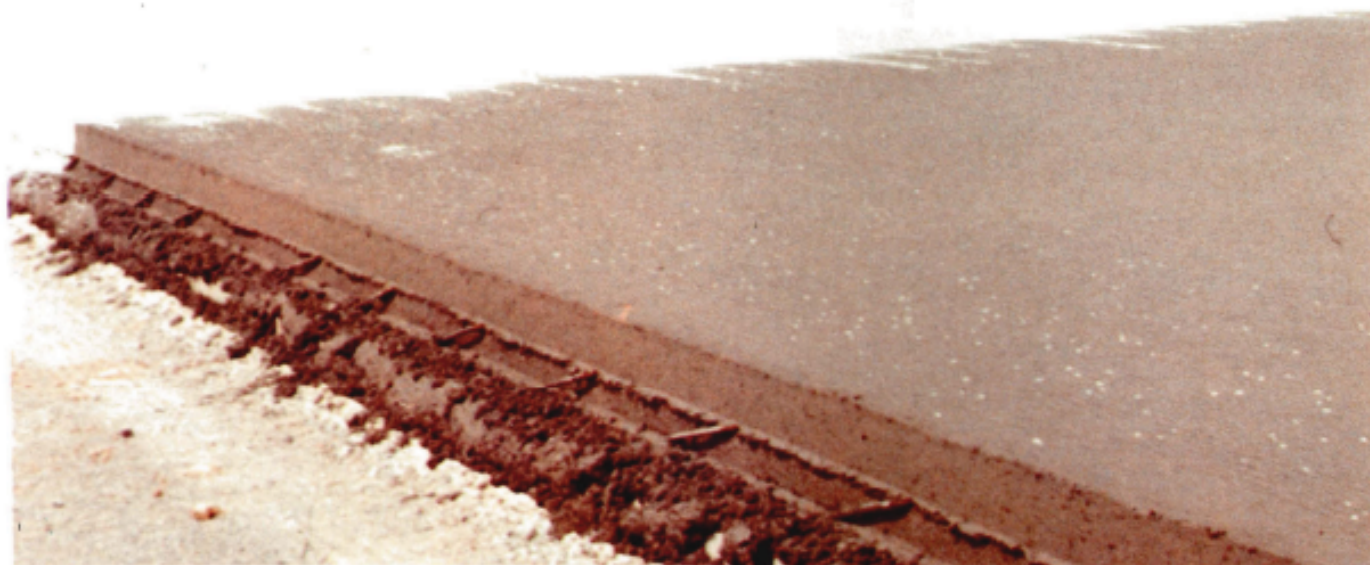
Pulverización de líquido filmógeno sobre pavimento de hormigón
